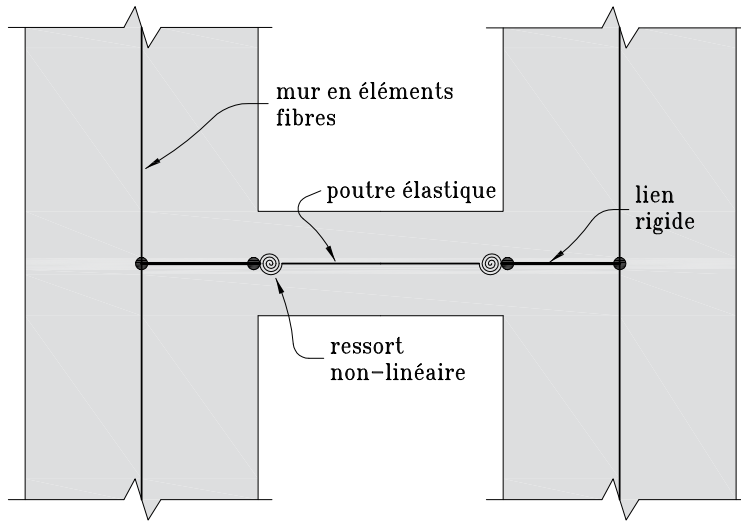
Représentation de la modélisation des murs et des poutres de couplage
